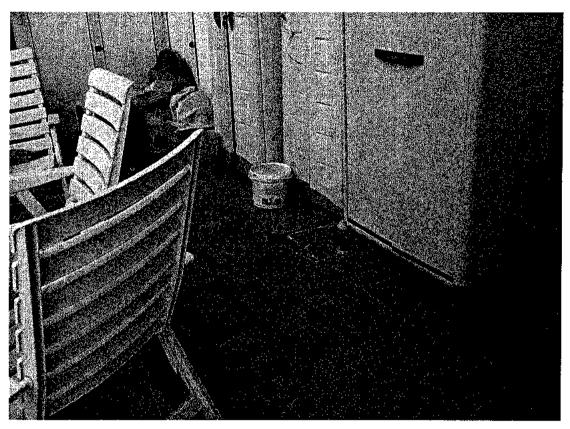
Rigonfiamento della pavimentazione in corrispondenza di un lucernario
